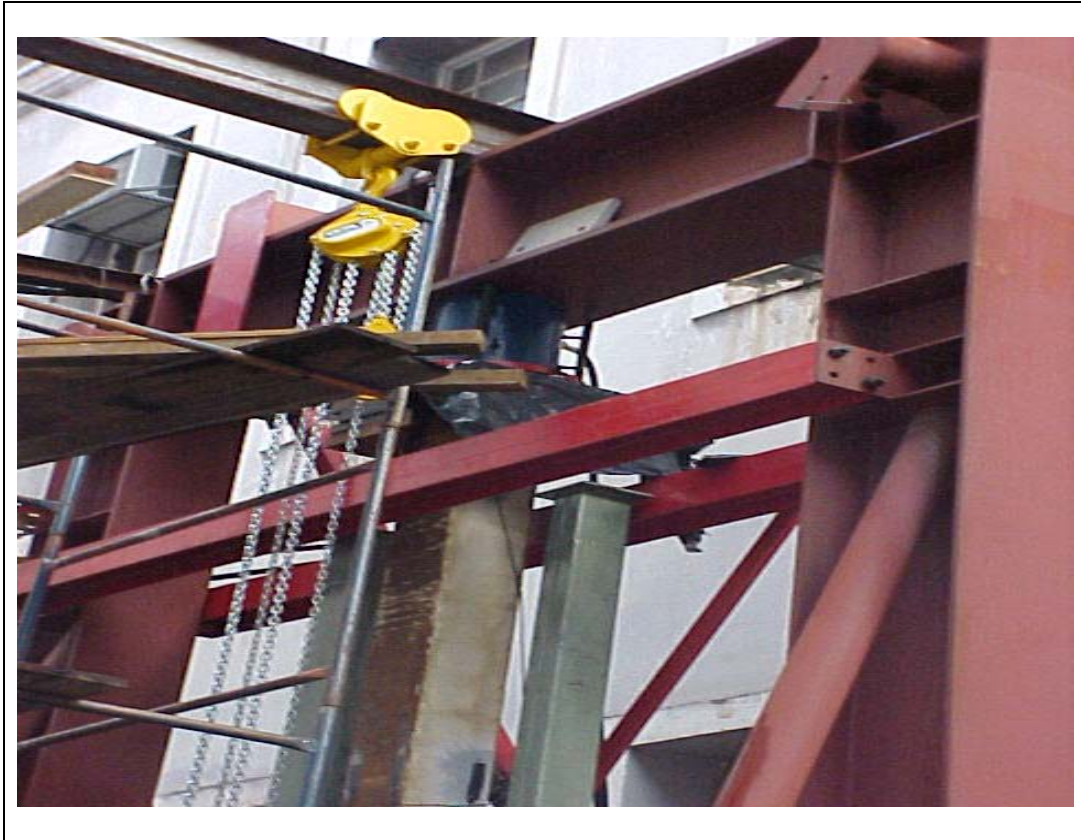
Pórtico de ensaio com talha de 3t durante a montagem do pilar.
